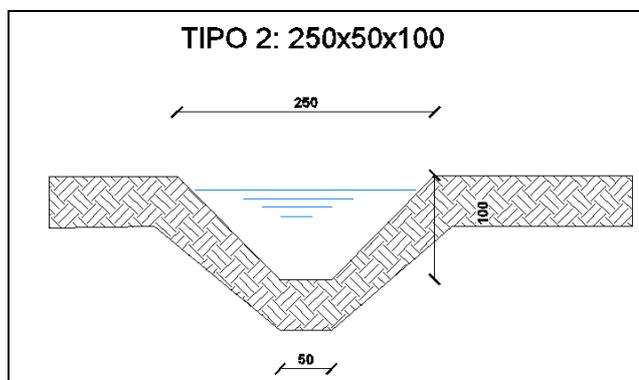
FOSSO DI COLLEGAMENTO TIPO 2
